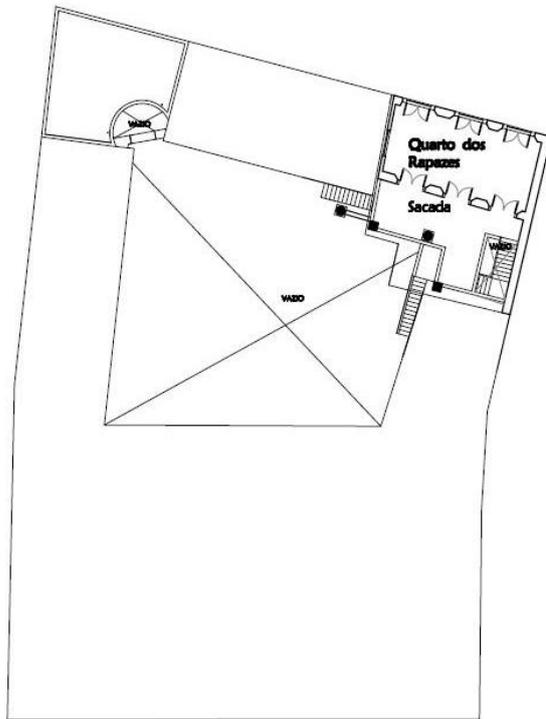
Uso original - Planta-baixa 1º Pav. bloco 2
